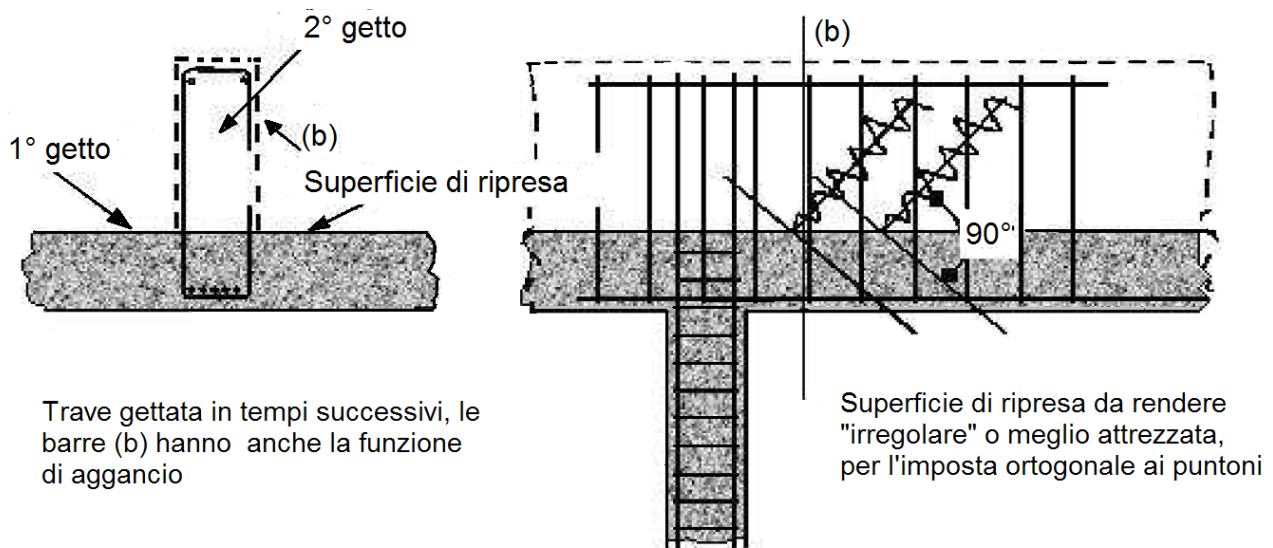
Modalità di ripresa del getto su travi di spessore elevato
